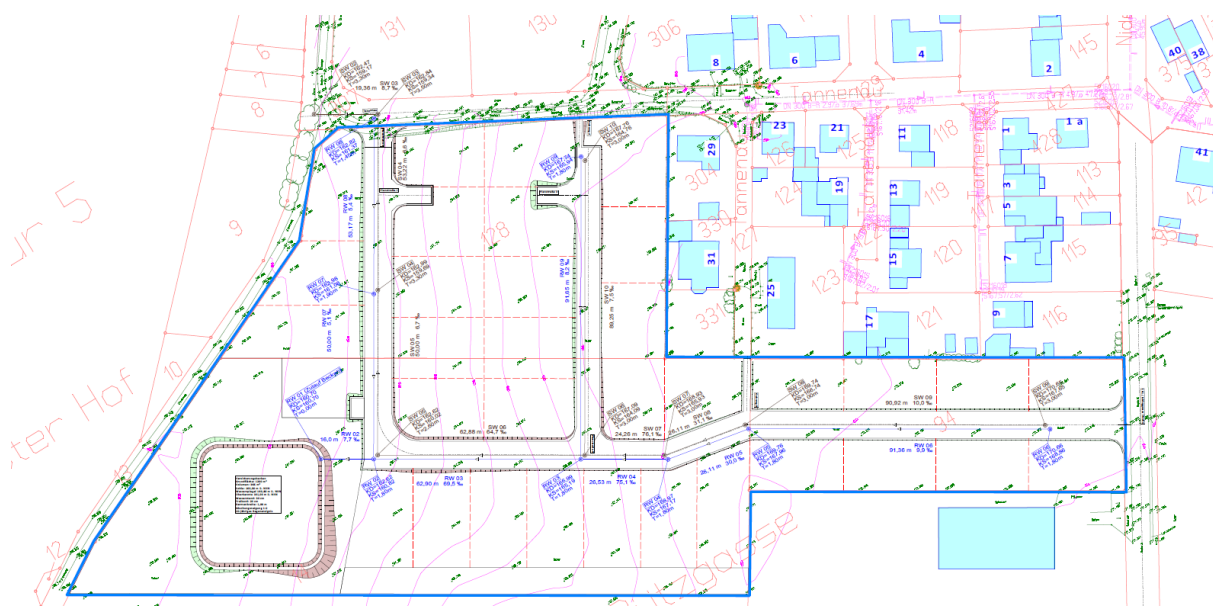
Lageplan - Neubaugebiet "Tannenau II"
